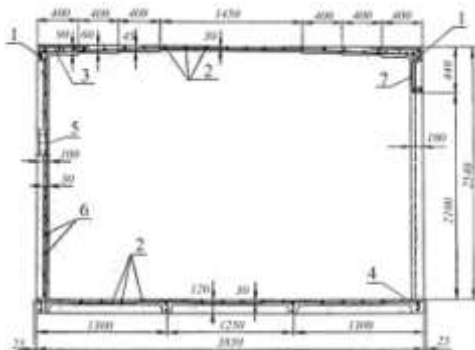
Схема армирования объемного блока в поперечном сечении: 1 – напрягаемая арматура (16-А800), 2 – сетка армирования (3-Вр500, S=200), 3 – сетка дополнительного армирования, 4 – каркас (продольная арматура: верхняя 12-А400, нижняя 10-А400; поперечная 4-Вр500, S=100), 5 – каркас (продольная арматура 8-А400, поперечная 3-Вр500, S=100), 6 – сетка (3-Вр500, S=250), 7 – каркас (продольная: 10-А400(в), два стержня 12-А400; поперечная 3-Вр500, S=125)
